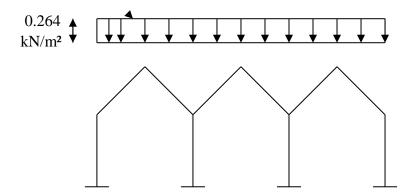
Charges de la neige sur la toiture sans accumulation.
